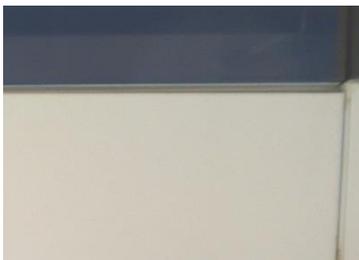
Panel de la puerta inclinado – ancho de la apertura cambiado
